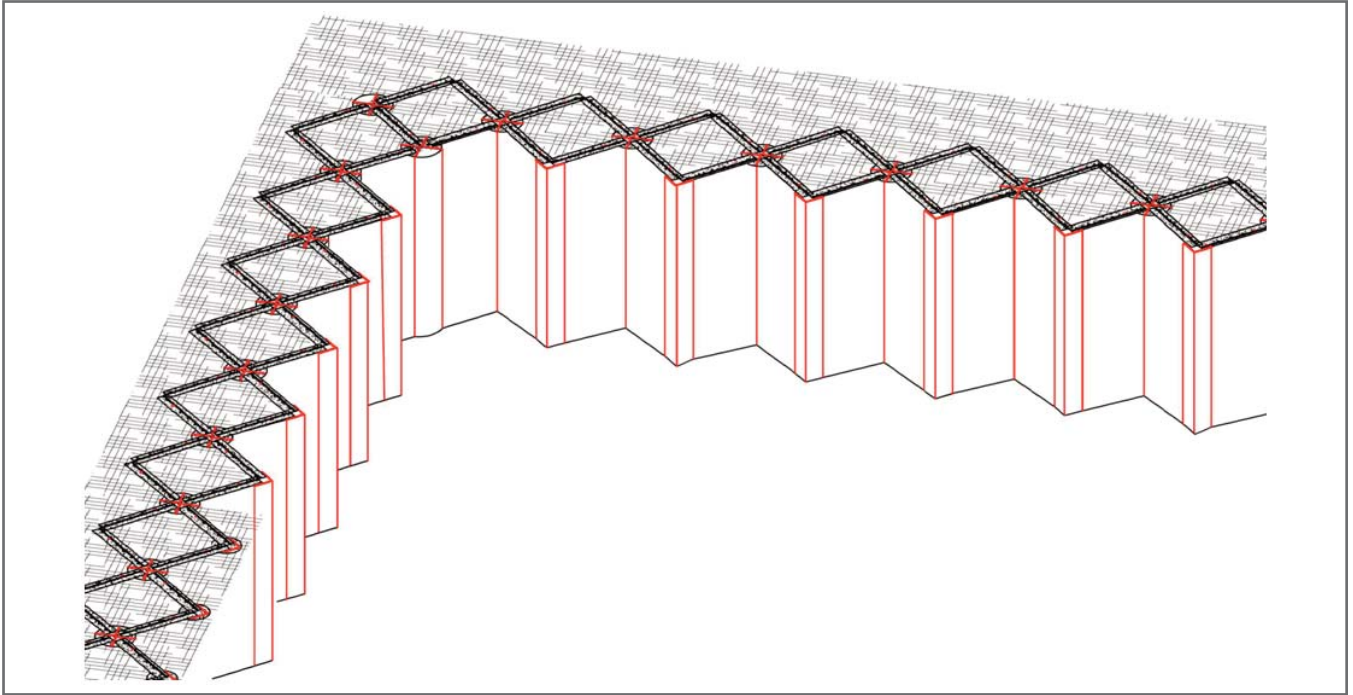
Схема варианта объемной сотовой конструкции, созданной с использованием метода узких прорезей в грунте для крепления котлована
